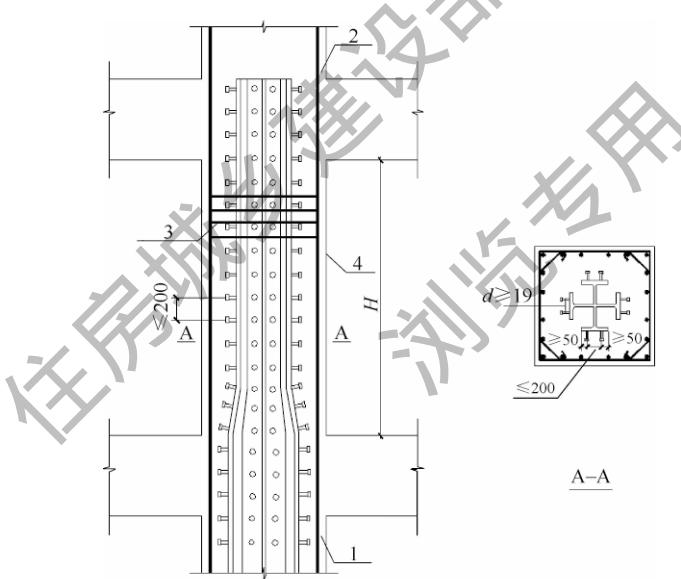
型钢混凝土柱与钢筋混凝土柱的过渡层连接构造
